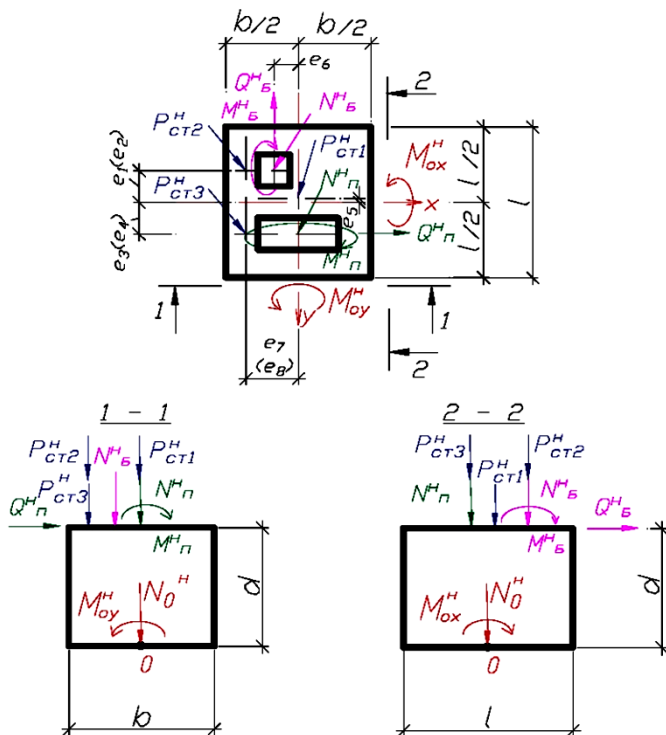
Приведение нагрузок к центру подошвы фундамента
